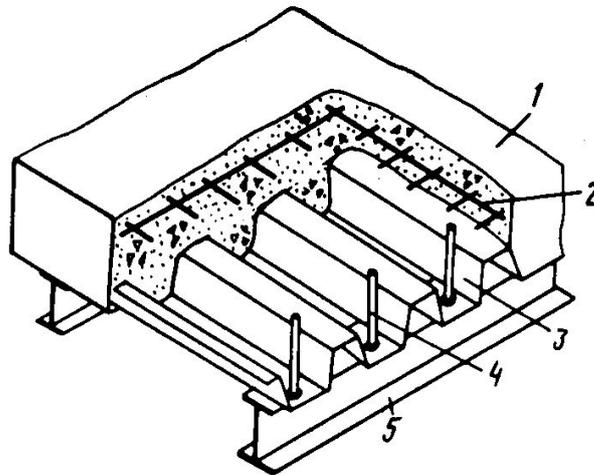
Конструкция монолитного перекрытия по СПН с вертикальными стержневыми анкерами: 1 - монолитный бетон; 2 - арматурная сетка; 3 - стальной профилированный настил; 4 – вертикальный анкер; 5 – прогон
